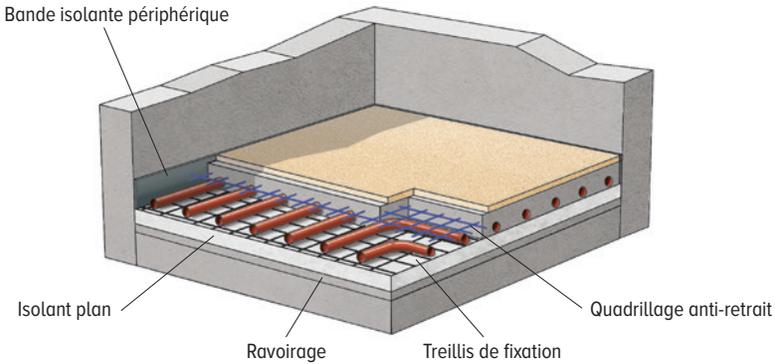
Fixation du tube caloporteur sur treillis soudé en pose directe sur l'isolant plan
